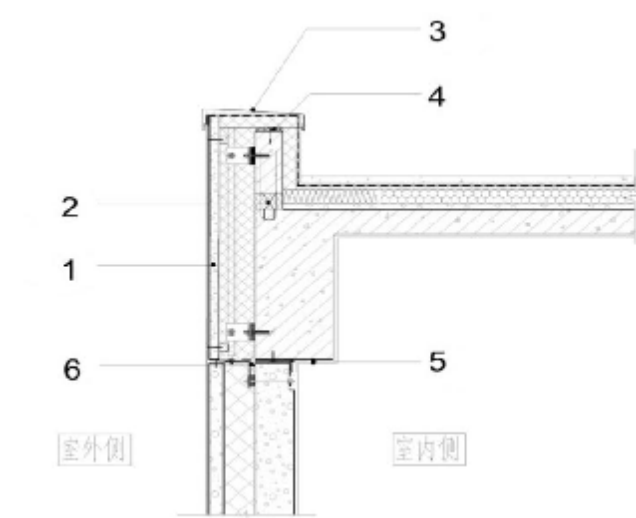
蒸压加气混凝土外墙板系统女儿墙保温做法示意图
